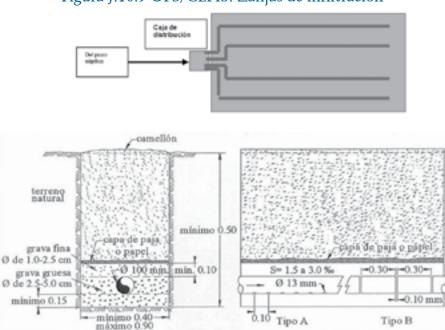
OPS/CEPIS. Zanjas de infiltración
